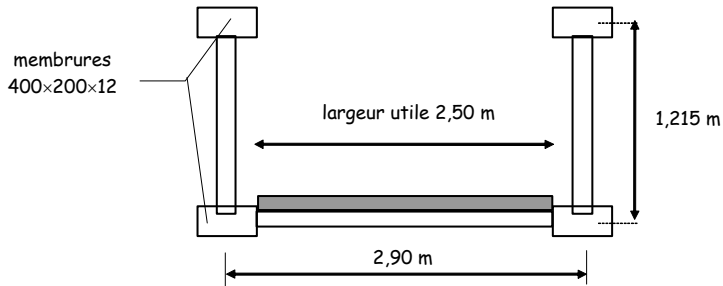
Section transversale de la passerelle à poutres latérales
